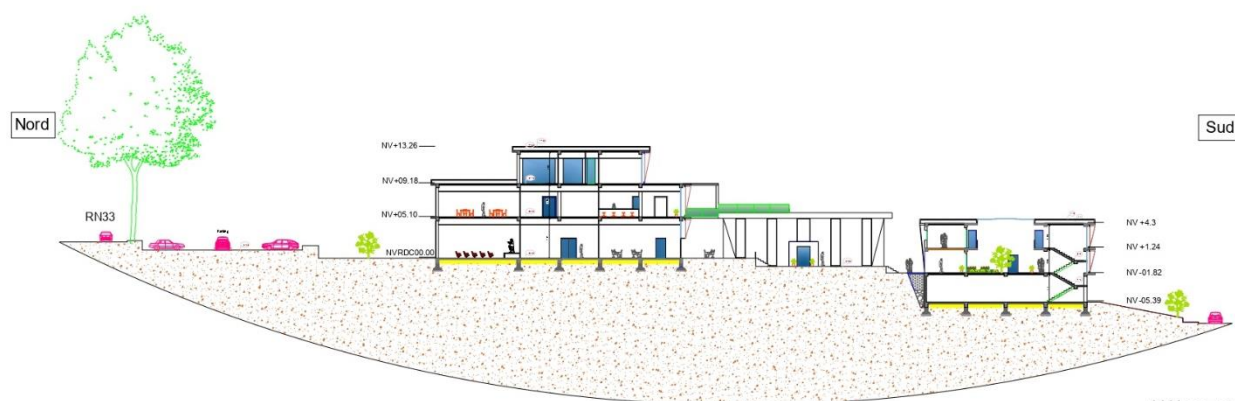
Coupe d'implantation de projet suivant la direction de la pente. Source : Auteurs.
